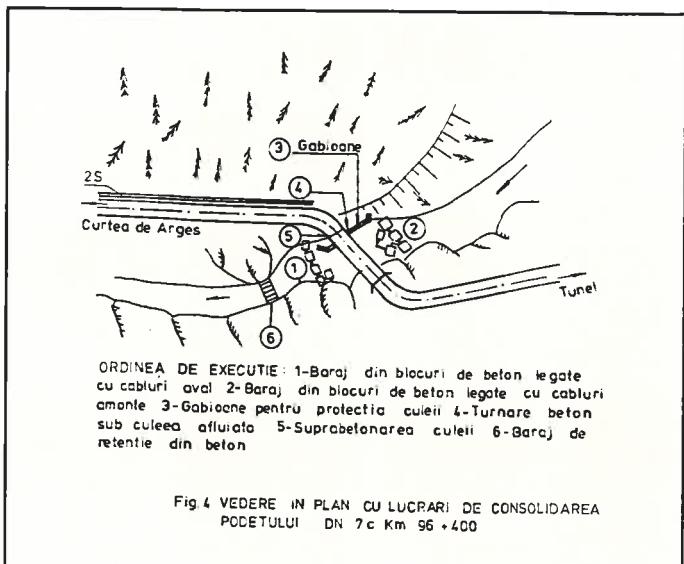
VEDERE IN PLAN CU LUCRARI DE CONSOLIDAREA PODETULUI DN 7c Km 96 + 400
